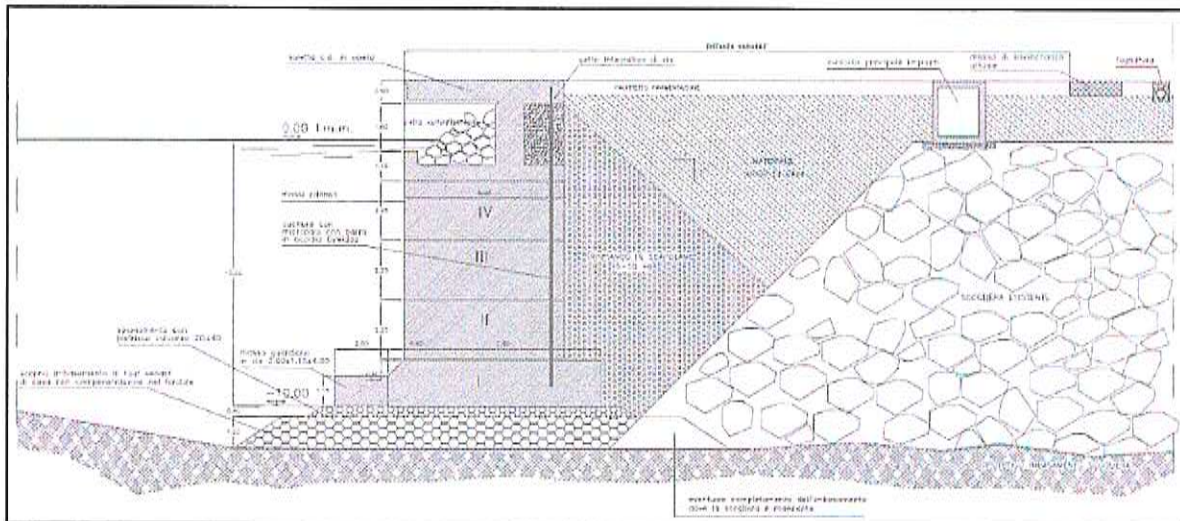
Sezione tipo banchina in massi pilonati con cella antiriflettente.
